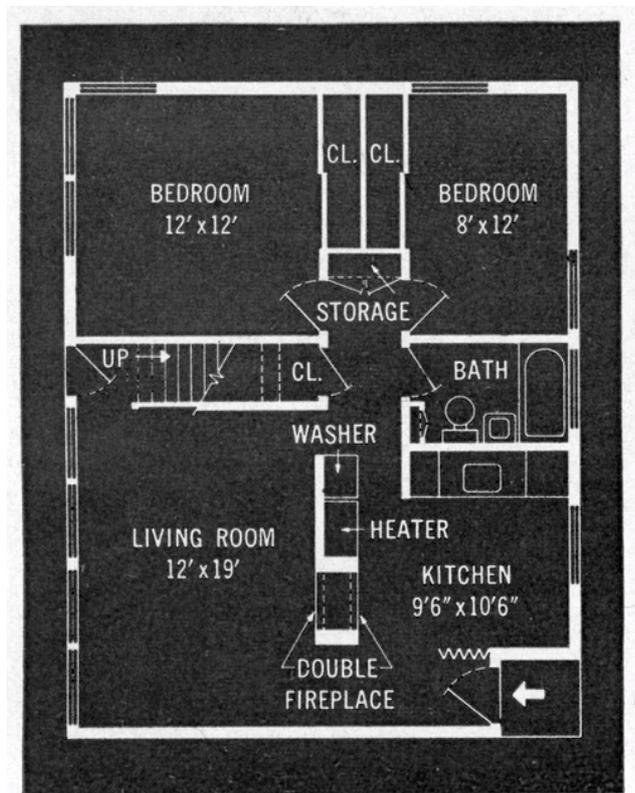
| Ranch House. Planta tipificada de um habitação em Levittown. 1949.
